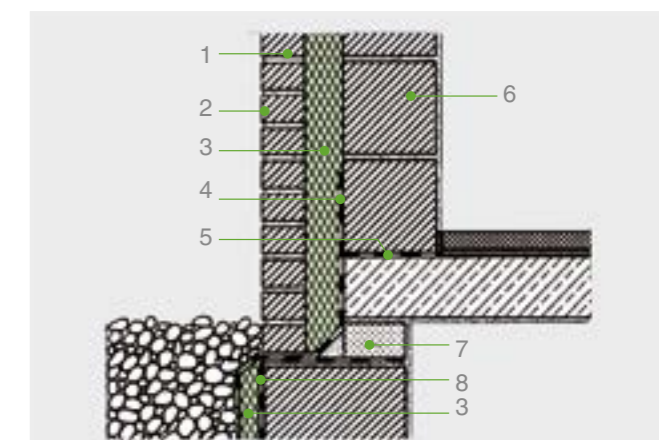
Punto inferiore dell'isolamento perimetrale. La lastra di Styrodur® è posizionata verticalmente sulle fondamenta.
